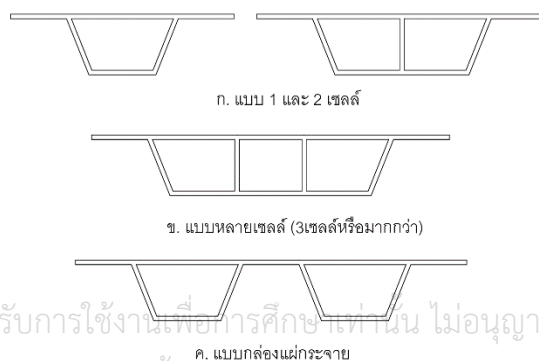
การก่อสร้างสะพานแบบ Segment Box Girder ในปัจจุบัน
